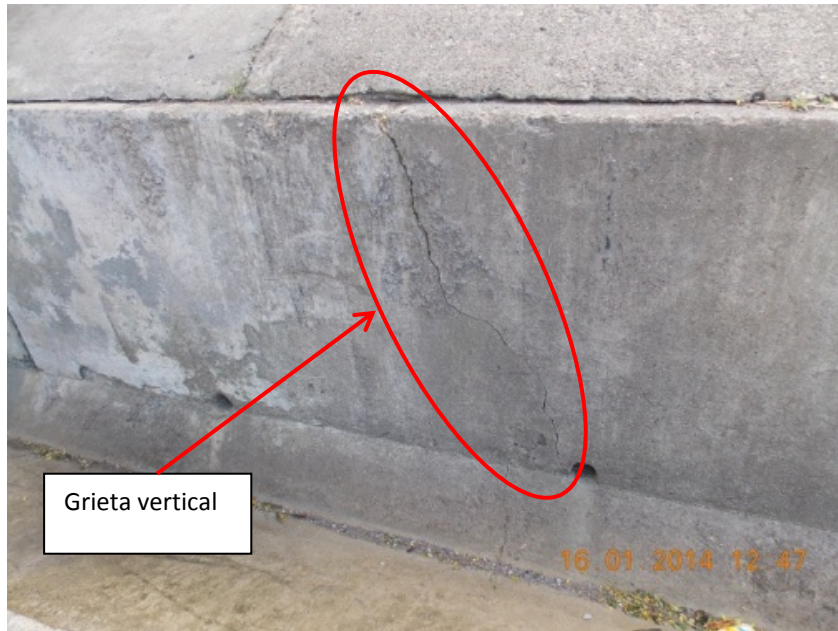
Grieta vertical en muro de retención del talud frente al bastión 2.
